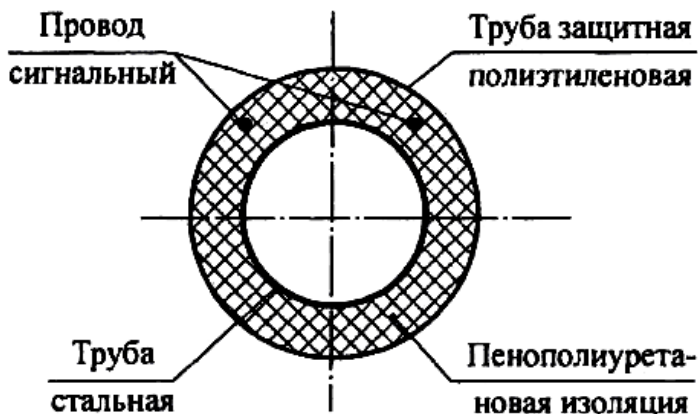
Конструкция предварительно изолированного трубопровода
